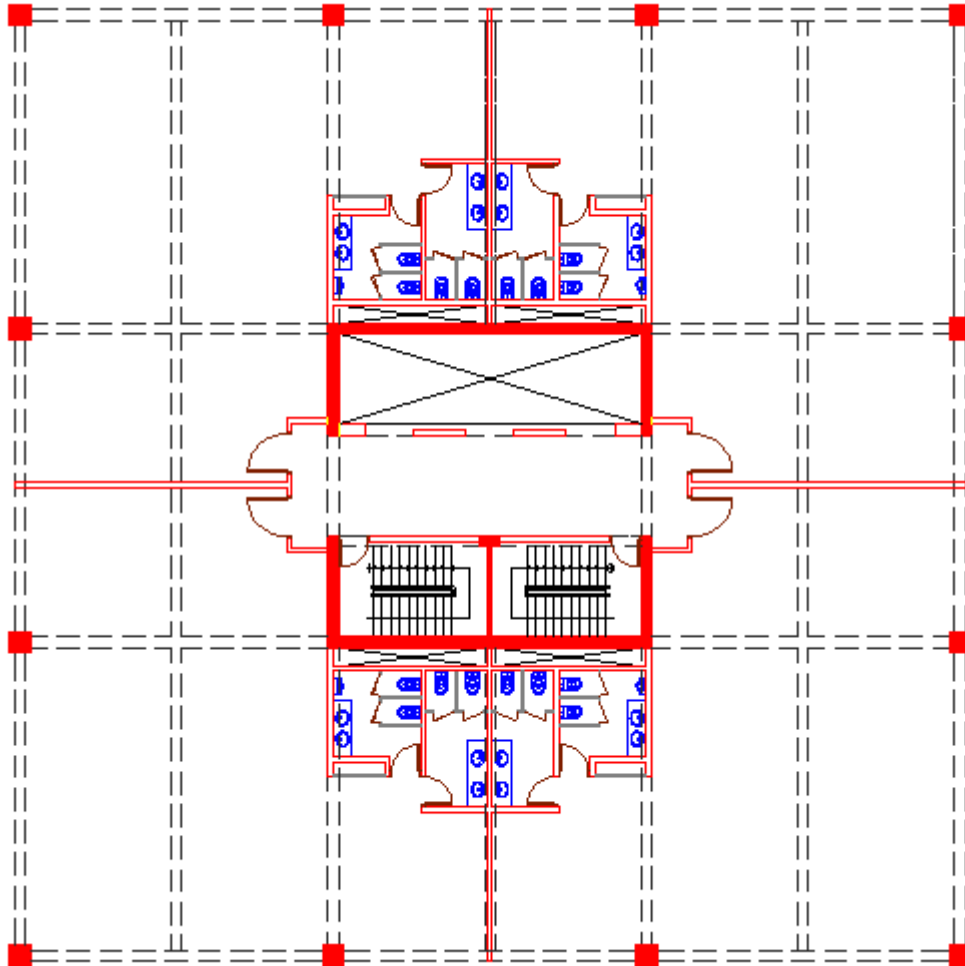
Planta arquitectónica típica del segundo al noveno piso.
